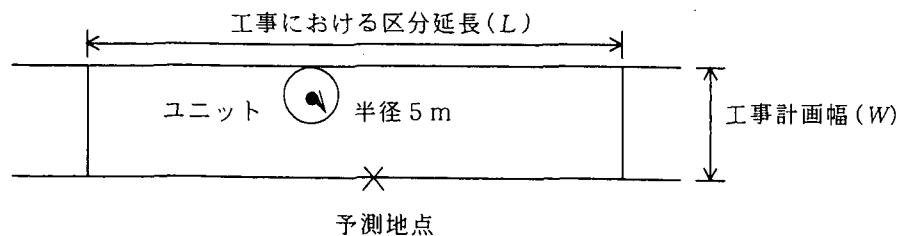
施工範囲が特定される場合の施工範囲とユニットの配置例
